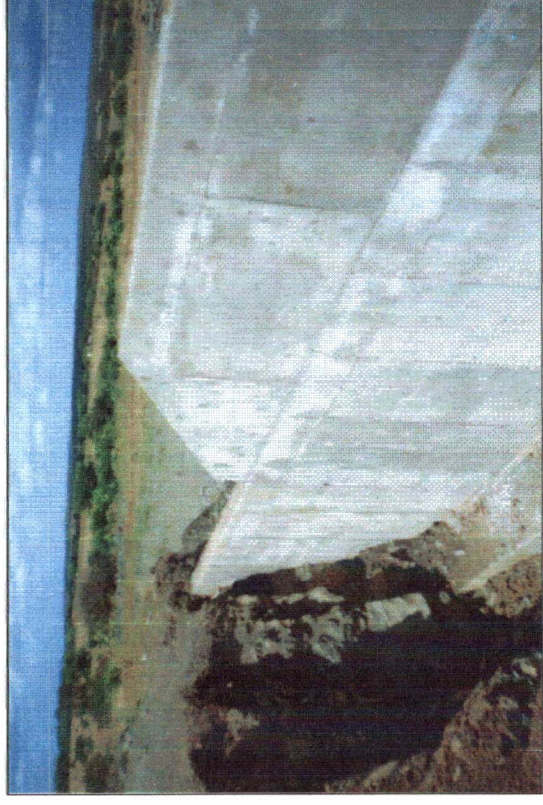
Vista do muro de contenção (est. 82), lado do reaterro do maciço.
